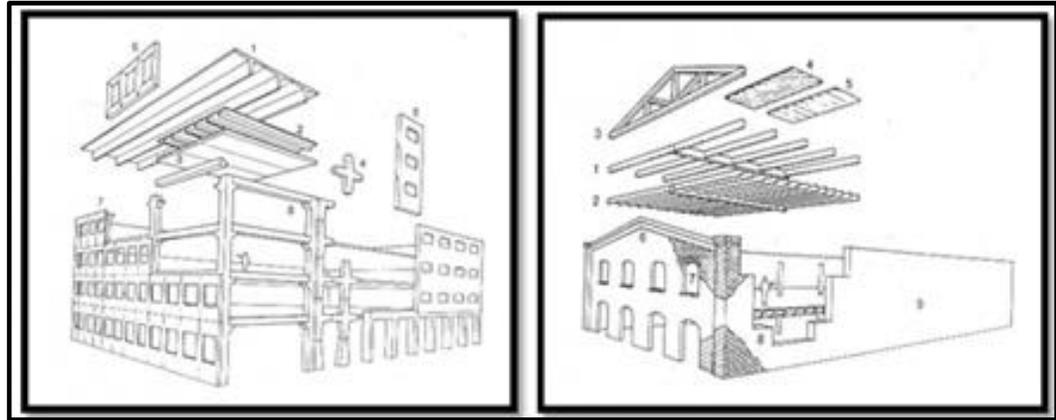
Construcción compuesta de relleno de mampostería no reforzada (MNR)
